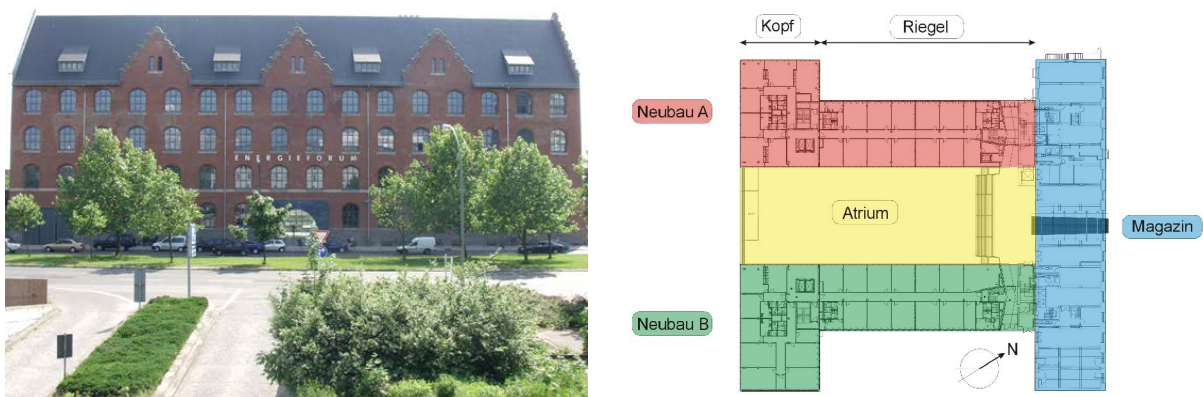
links: Nordost-Ansicht des Magazingebäudes; rechts: Grundriss des Gebäudes
